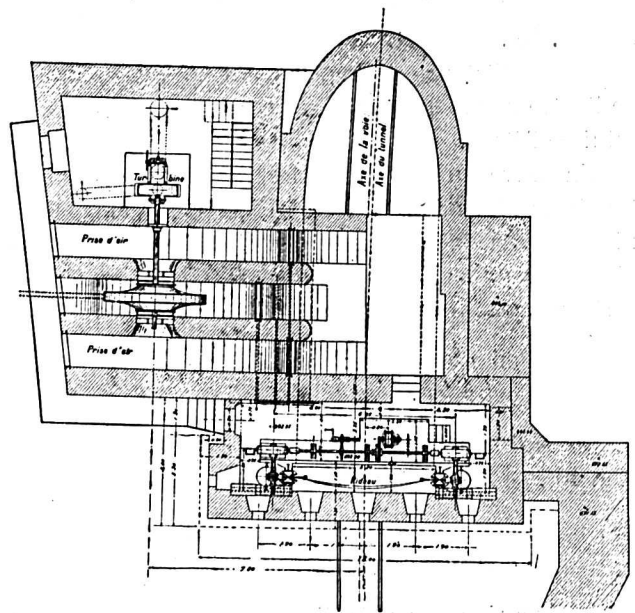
Coupe horizontale par C D, à la hauteur du ventilateur de l'étage.
